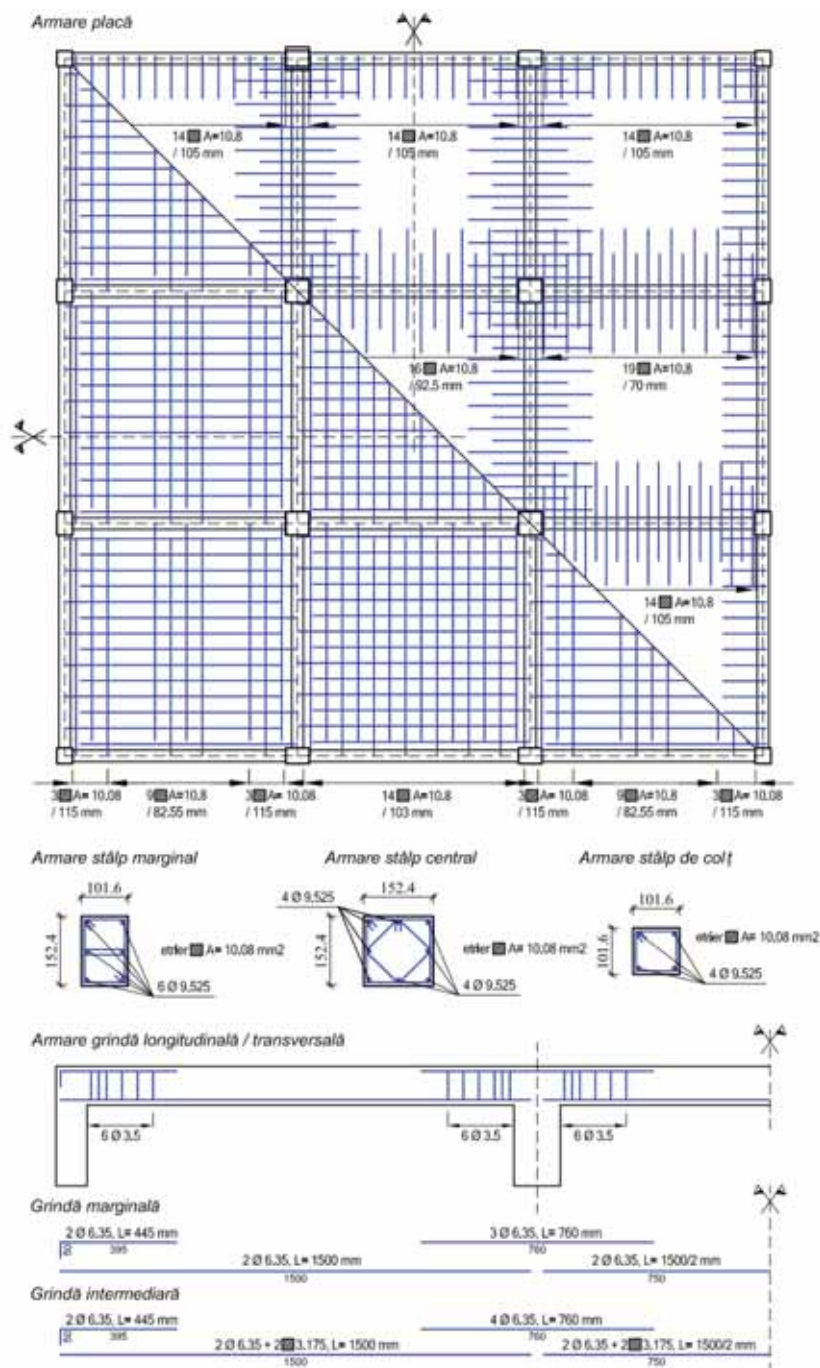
Detalii armare elemente structurale: placă, stâlpi, grinzi [136]
